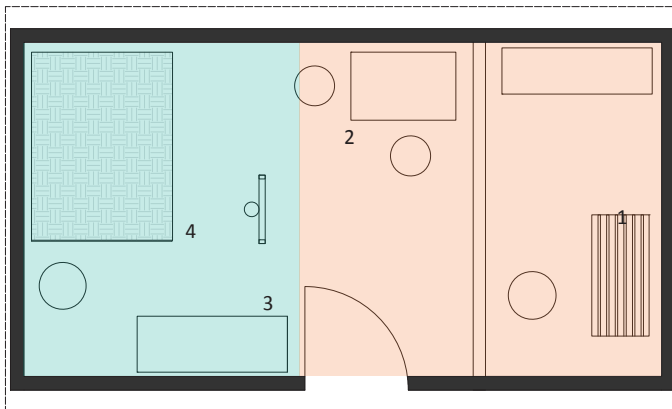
Análisis de planta arquitectónica casa andina de Otavalo
